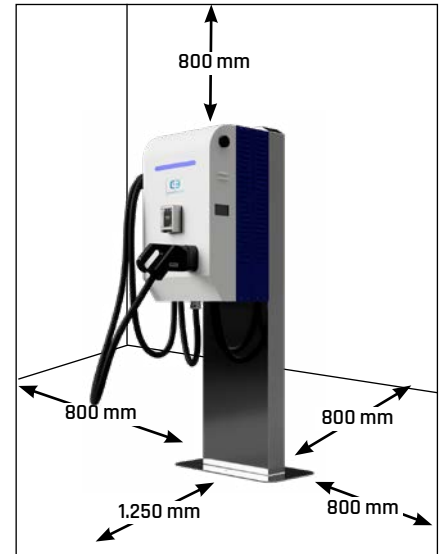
Mindestabstände (mm) Montage mit Standfuß.
